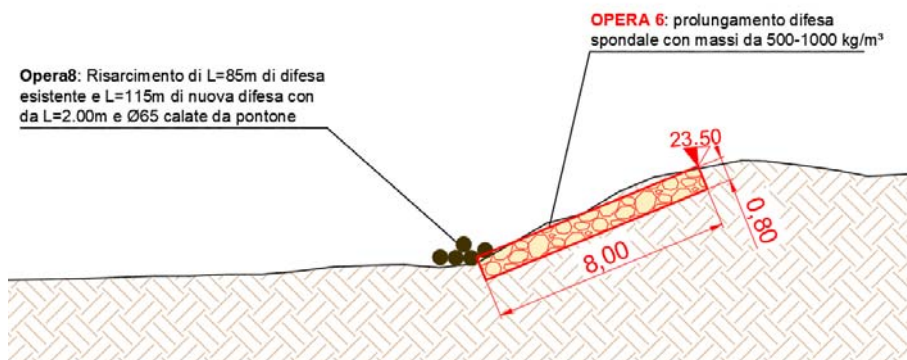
Opera 6 - Estratto Tav. PFTE.21 - Sezione Tipologica
